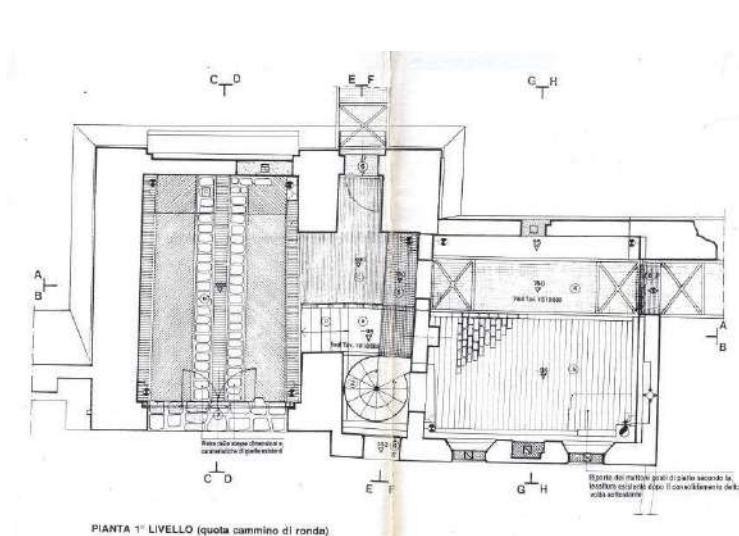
e 7 - Pianta e sezione progetto – FIO 1992
